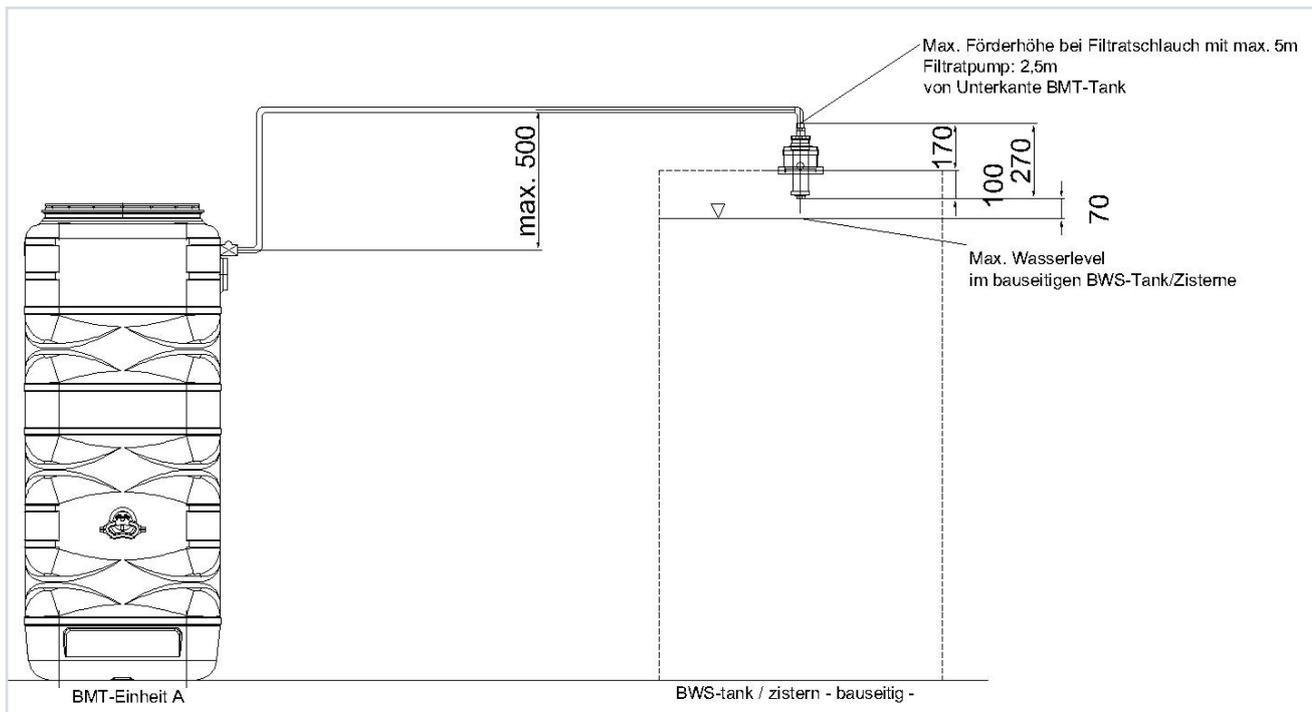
Anschluss Filtratschlauch an FÜB der BMT-Einheit bei bauseitigem Betriebswassertank Variante 2
